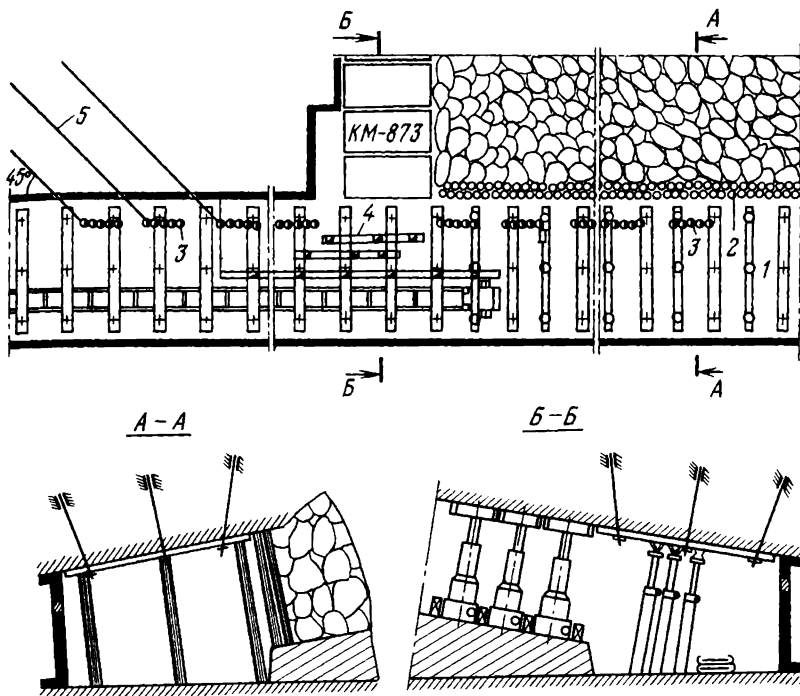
Схема крепления сопряжений лав с прилегающими выработками, сохраняемыми для повторного использования при отработке пластов с труднообрушаемыми кровлями
